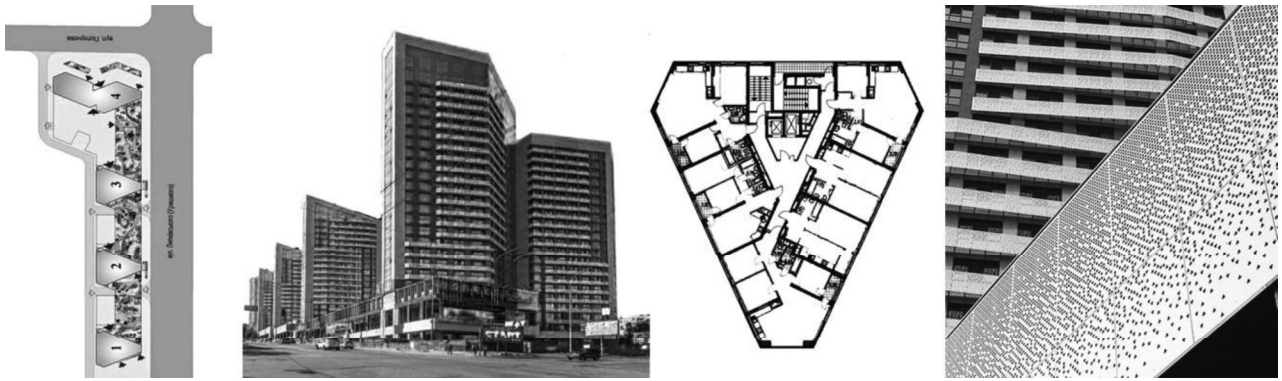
ЖК Квартет по вул. Липківського, Солом'янка. Генплан, загальний вигляд, план поверху, фрагмент фасаду [20, 21].
